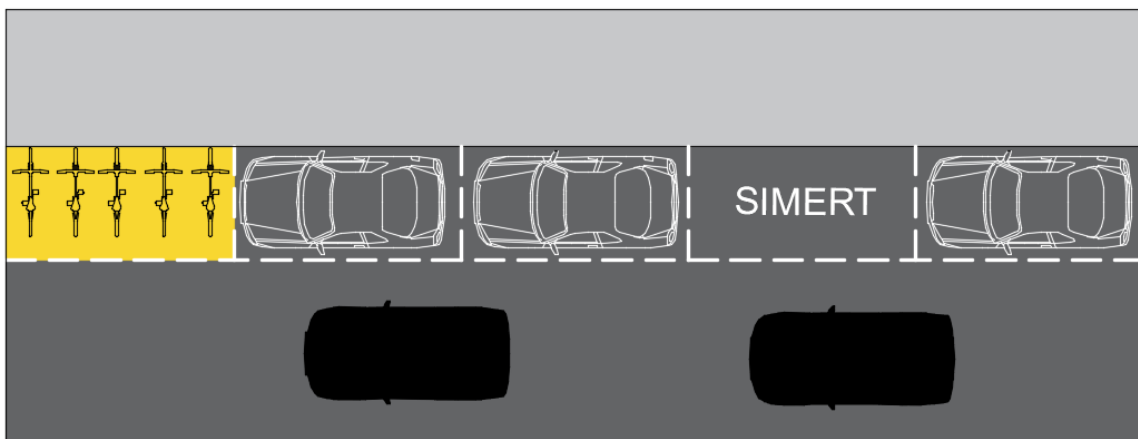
Propuesta de estacionamiento para bicicletas – Elaboración Autor
